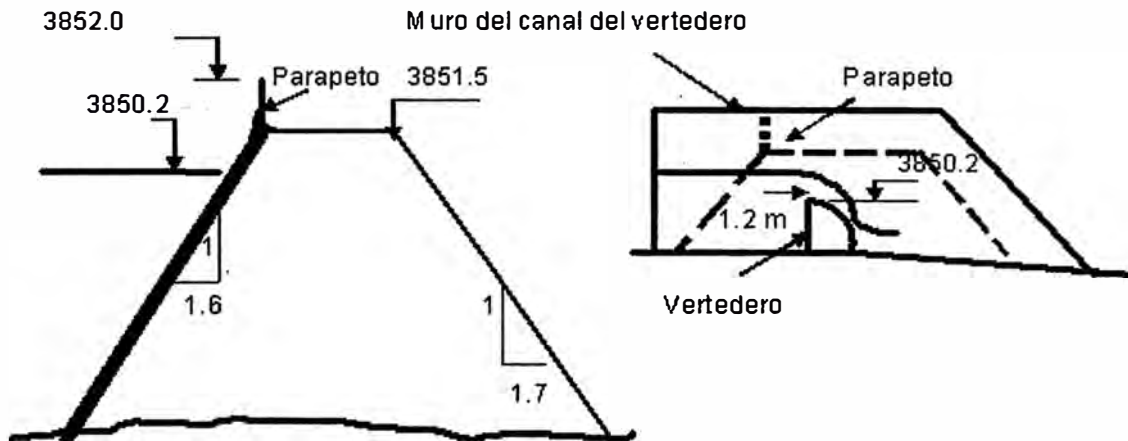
Esquema Ubicación del Parapeto y Muro del Canal del Vertedero
